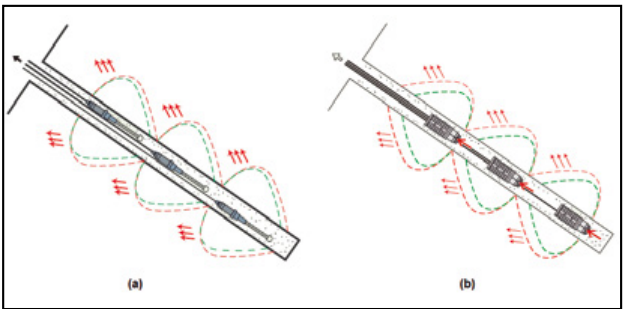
Esquema de anclajes con carga distribuida: (a) anclaje de tracción; (b) anclaje de compresión (Samwoo Anchor Technology, 2014).
